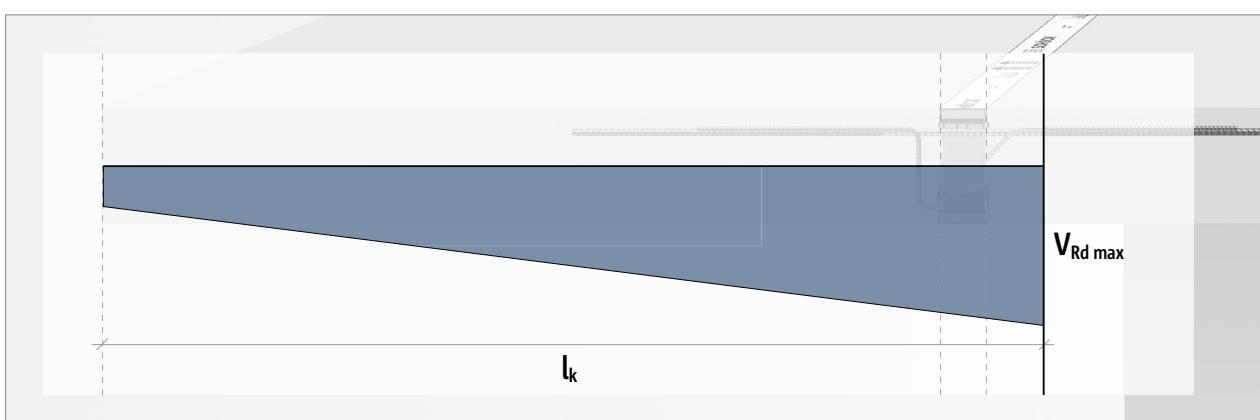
Schöck Isokorb® T tip KL: projektne obremenitve
